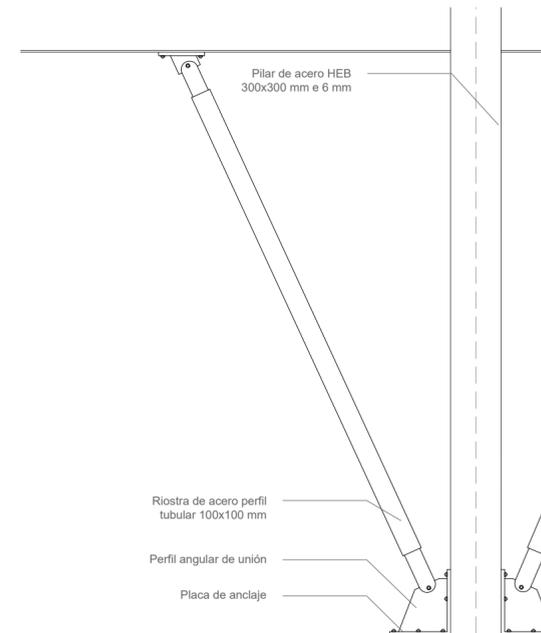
elevación de la unión entre pilar, viga y riostra. Fuente: Elaboración propia
